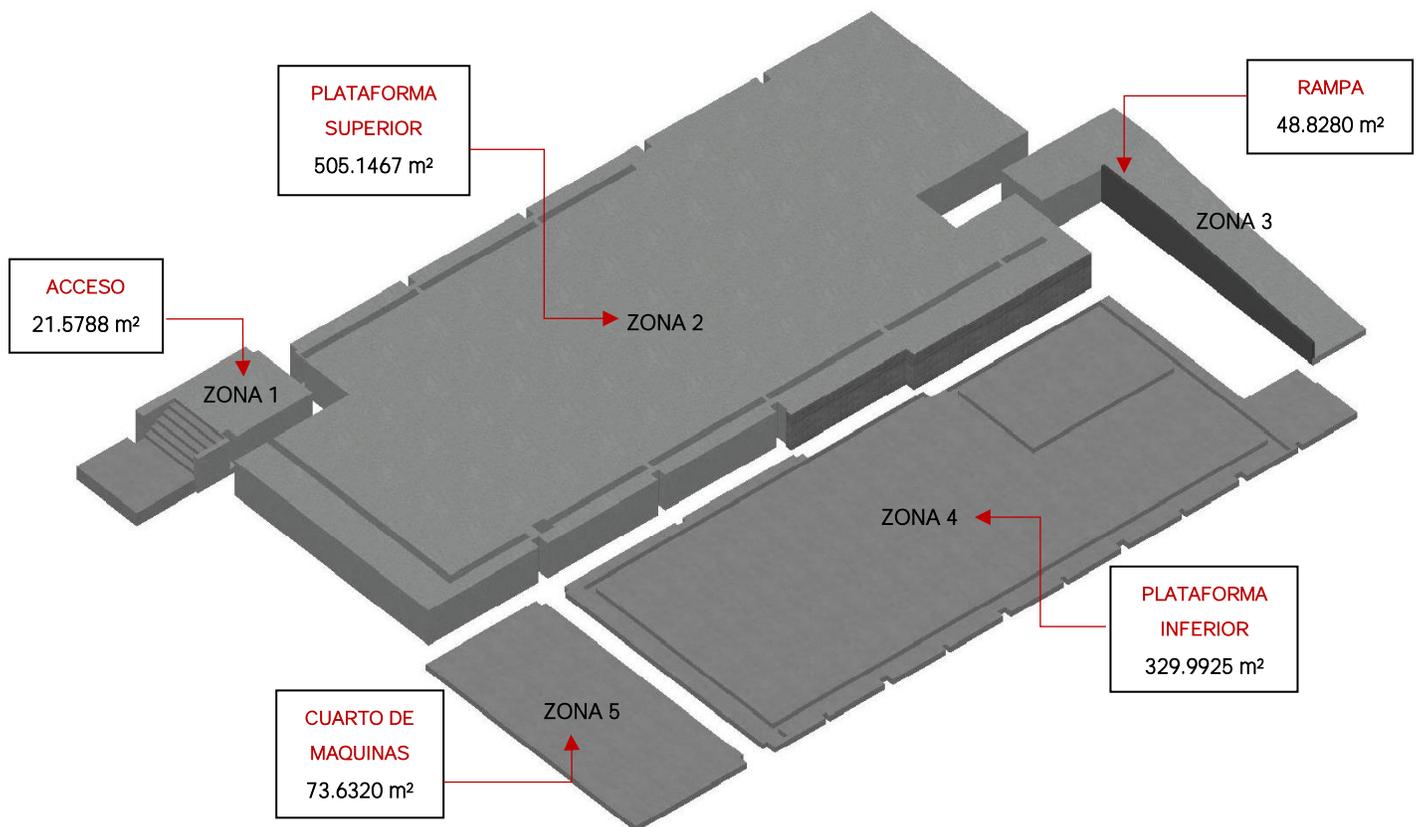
Modelo 3D- División de zonas en Planta Piloto.
